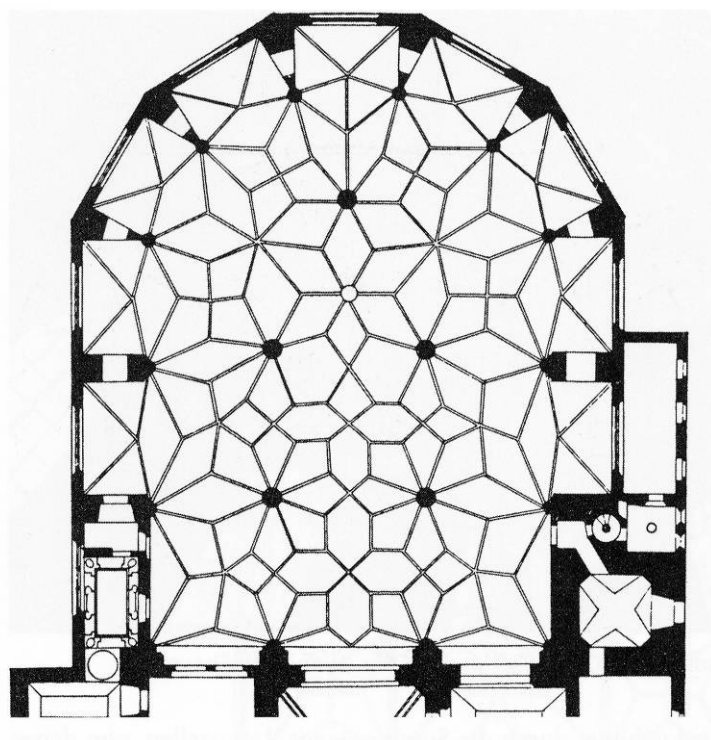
Salzburg, Franziskanerkirche, Chor, Grundriss.
